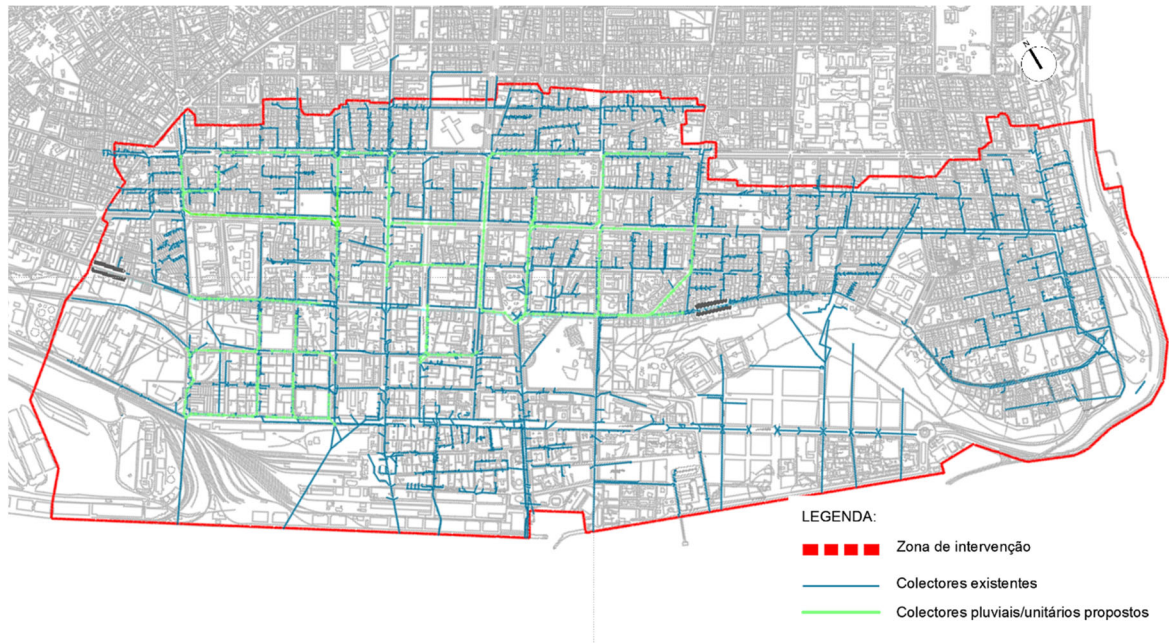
Planta esquemática ilustrativa do traçado dos novos colectores pluviais/unitários propostos
